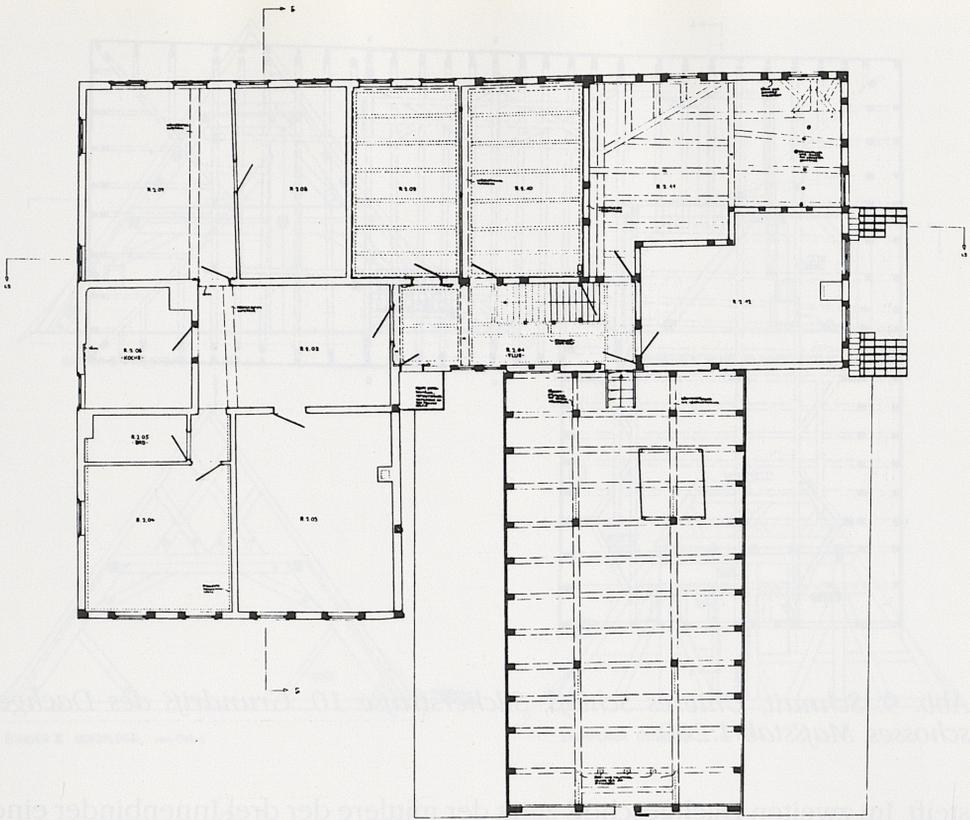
Schnait, Unterer Schloß, Silcherstraße 10. Grundriß des zweiten Obergeschosses, Maßstab 1:200.
